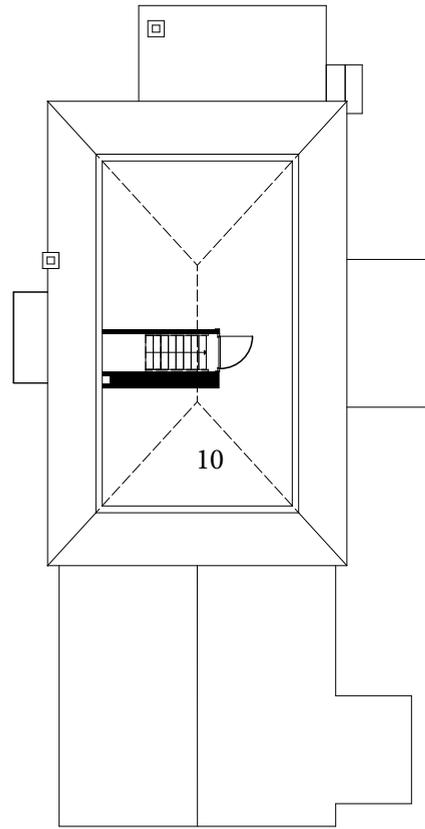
Grundriss Dachgeschoss 3. Bauphase 1:200
